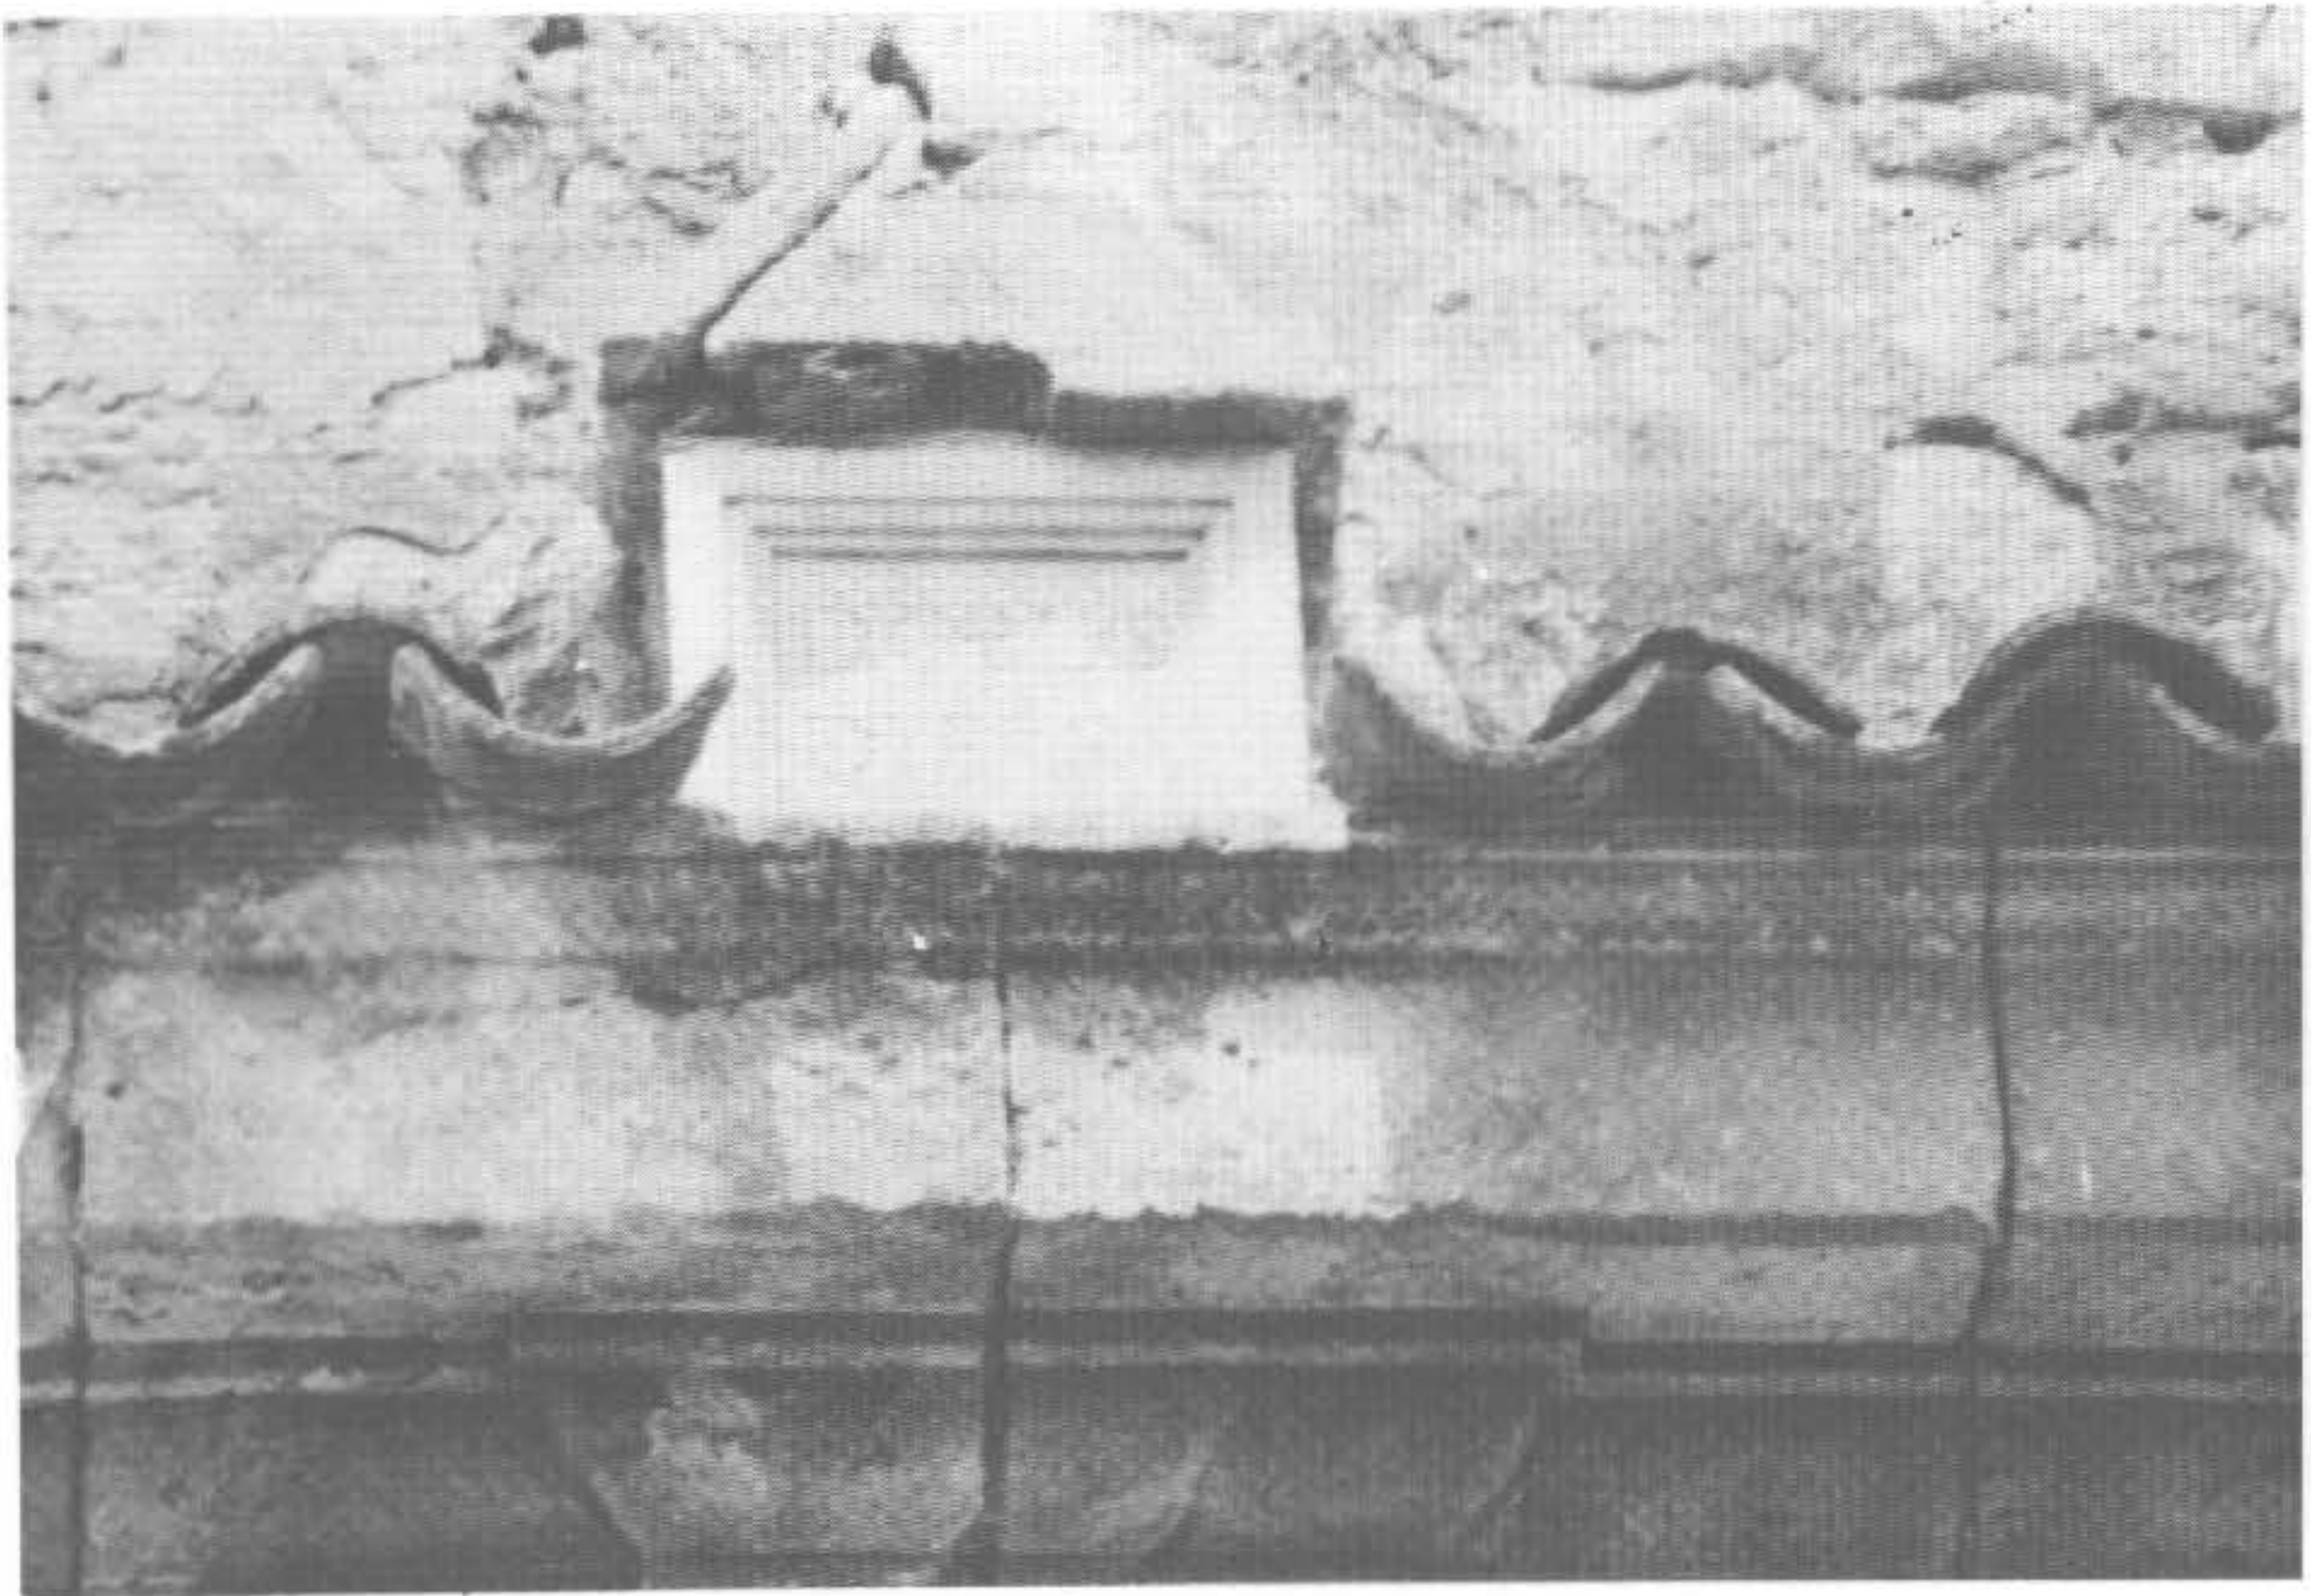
CENTENERA (Guadalajara) Iglesia Parroquial
